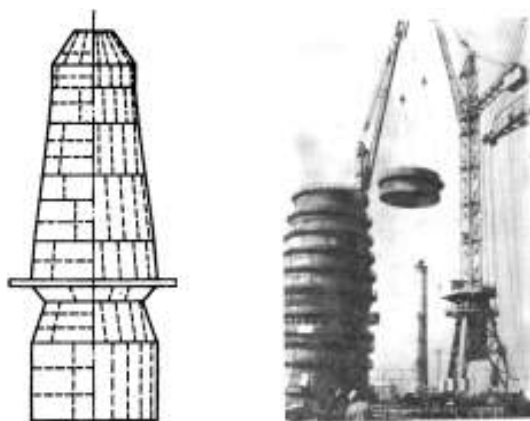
Примеры выполнения сварных конструкций в технике
